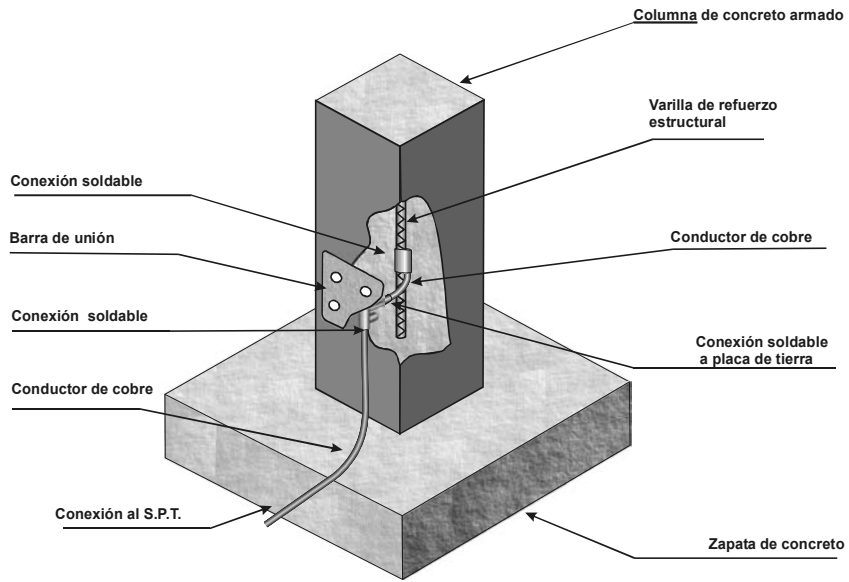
Detalle típico de conexión al acero de refuerzo
